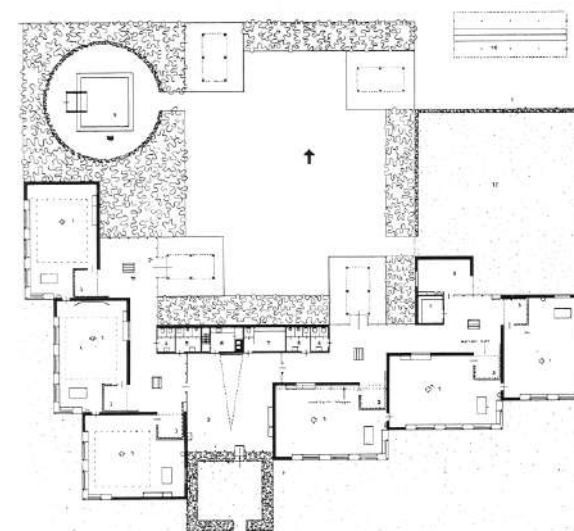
Planta de una de las escuelas en Nagele, de Aldo van Eyck. Fuente: Strauven, 1998, p. 281.
